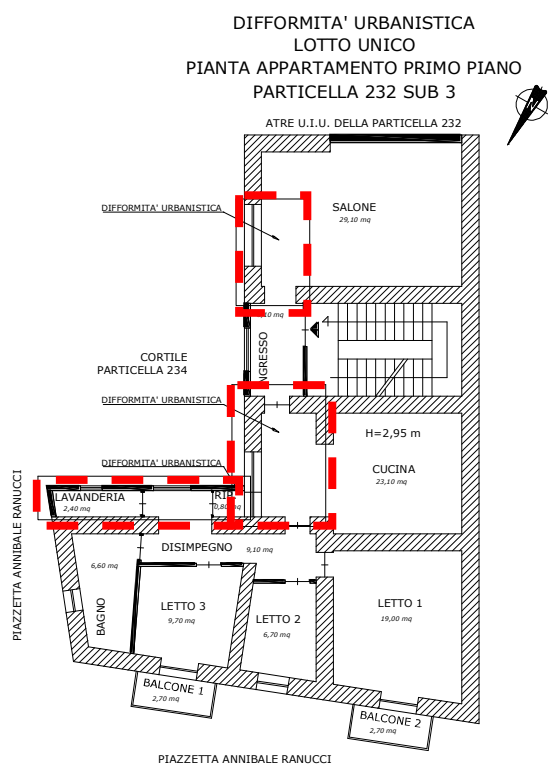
difformità urbanistica dell'appartamento e della Figura 32 pianta piano tipo secondo la L.E. n.39/76 primo piano
